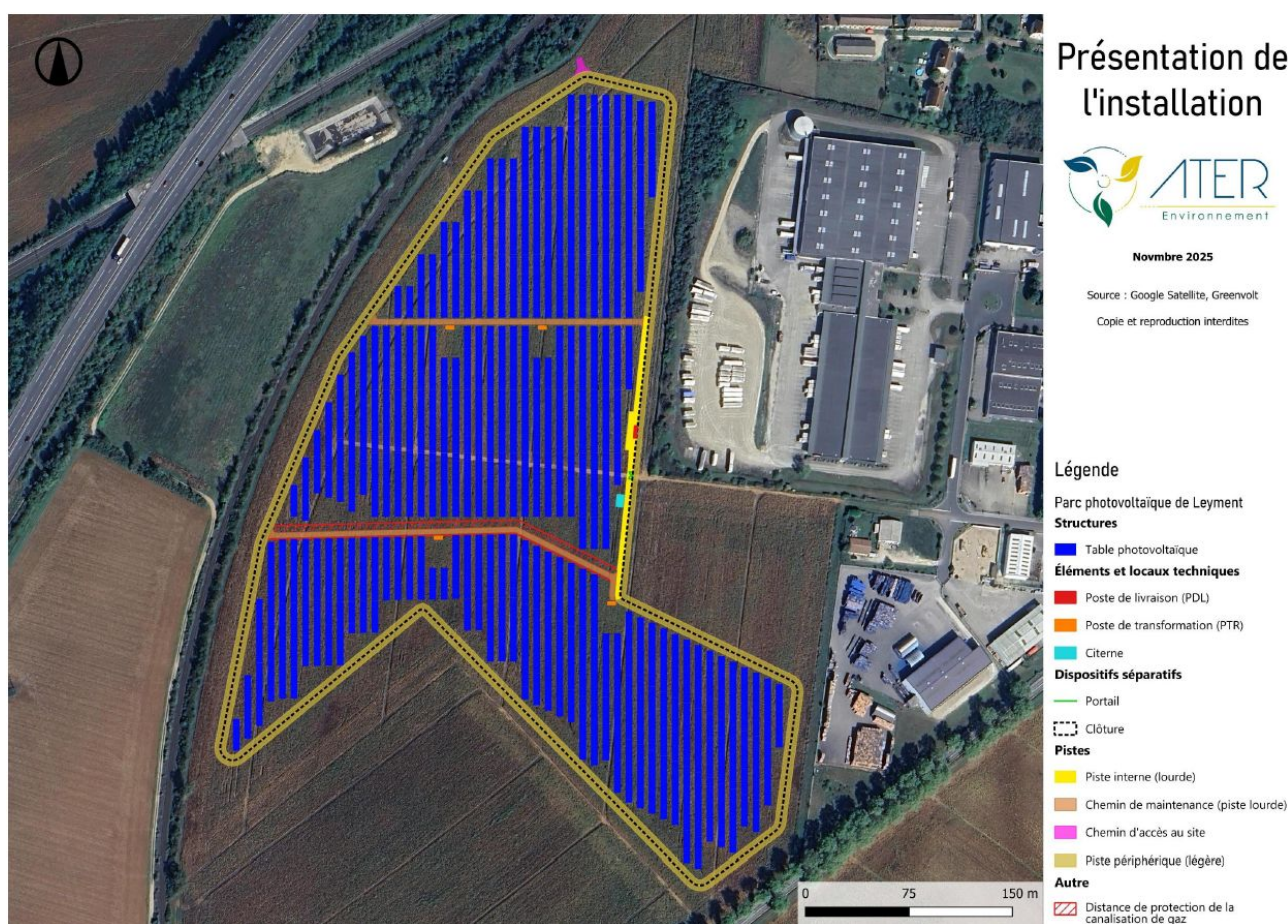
Plan d'implantation du projet (Source : étude d'impact)
